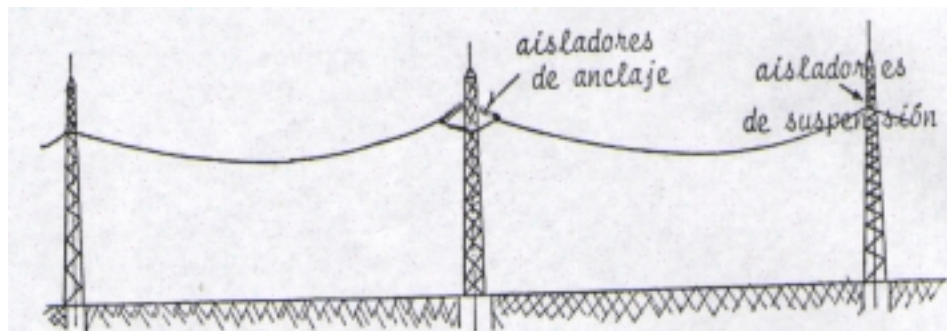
Representación esquemática de la posición de cadenas de aisladores para apoyo de alineación y para apoyos de anclaje
